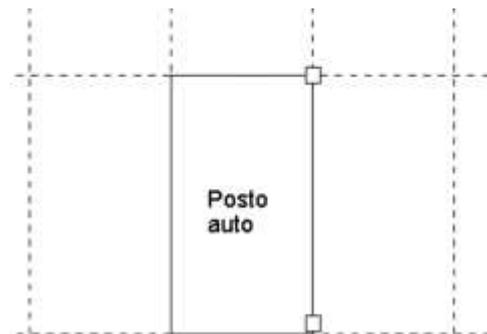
Estratto planimetria catastale, relativa al posto auto sub. 166
